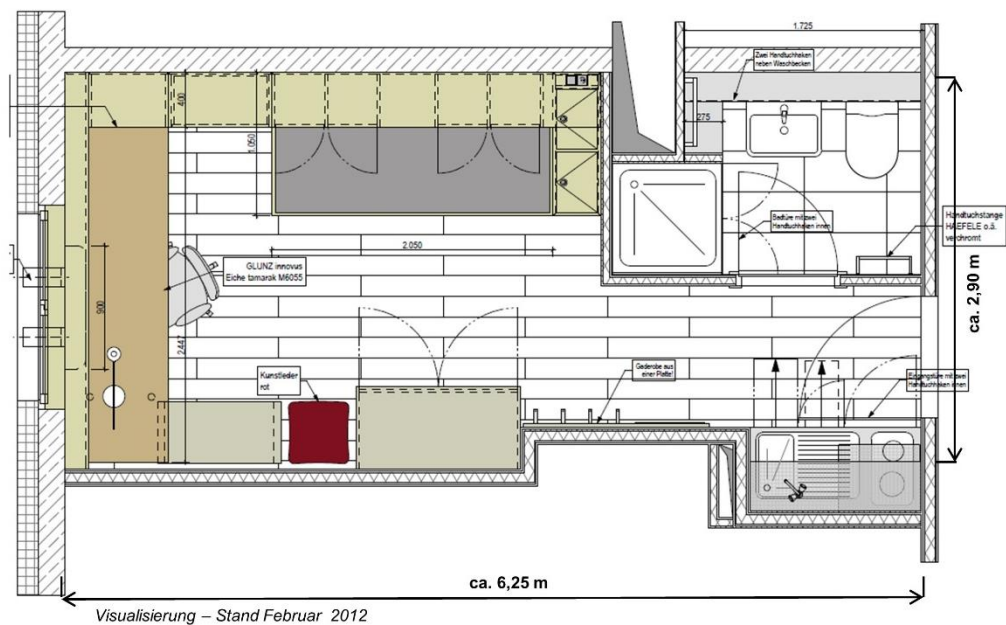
Mustergrundriss 1-Zimmer-Apartment⁸⁸
